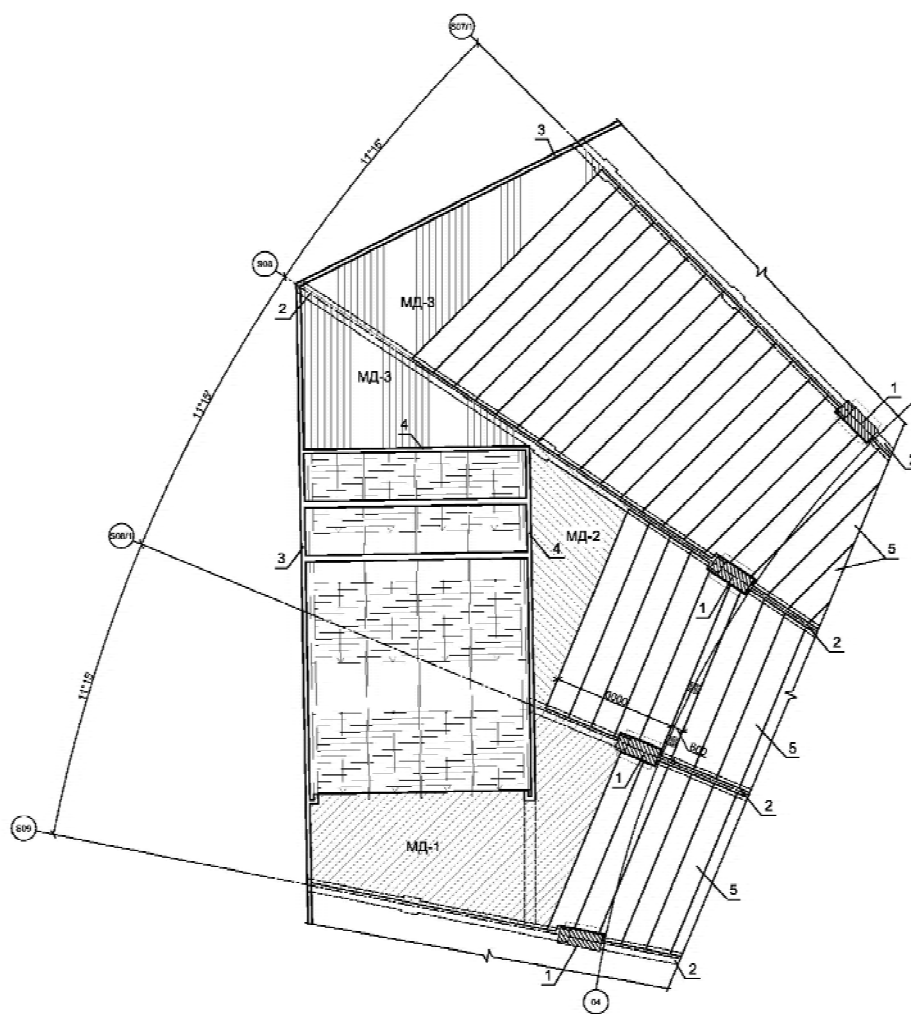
Схема розташування монолітних залізобетонних ділянок південно-західної частини перекриття: 1, 2 — відповідно залізобетонні колони і балки основного каркасу будівлі стадіону; 3 — контурні залізобетонні балки; 4 — залізобетонні балки сходової клітки; 5 — збірні плоскі залізобетонні плити перекриття.
